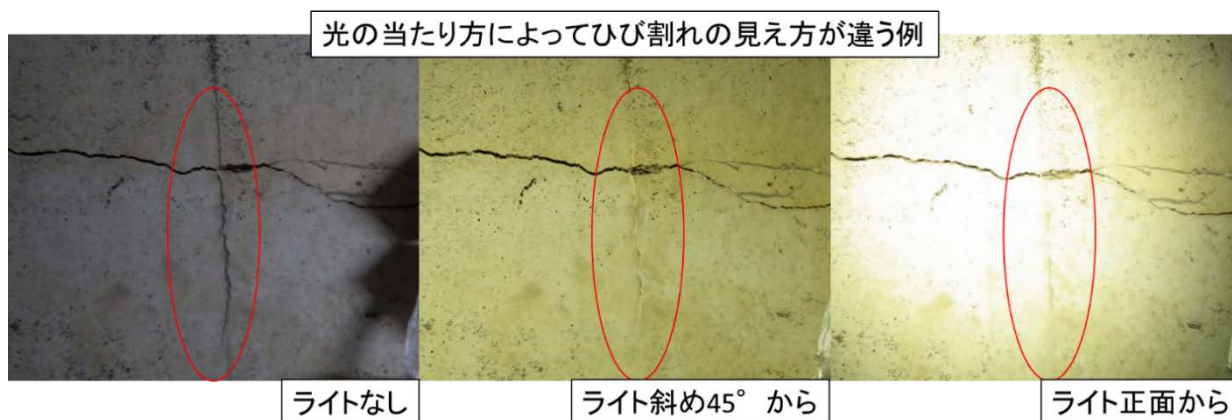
計測条件によるひび割れの見え方の違い
